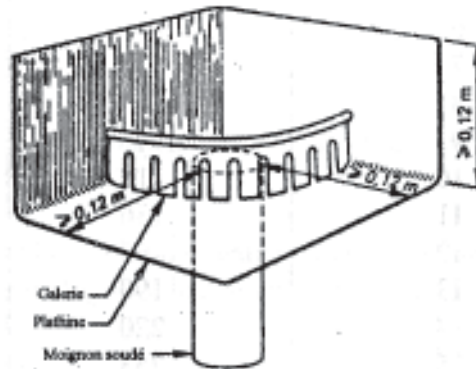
Dimensions de la platine d'évacuation des eaux pluviales près d'un angle
